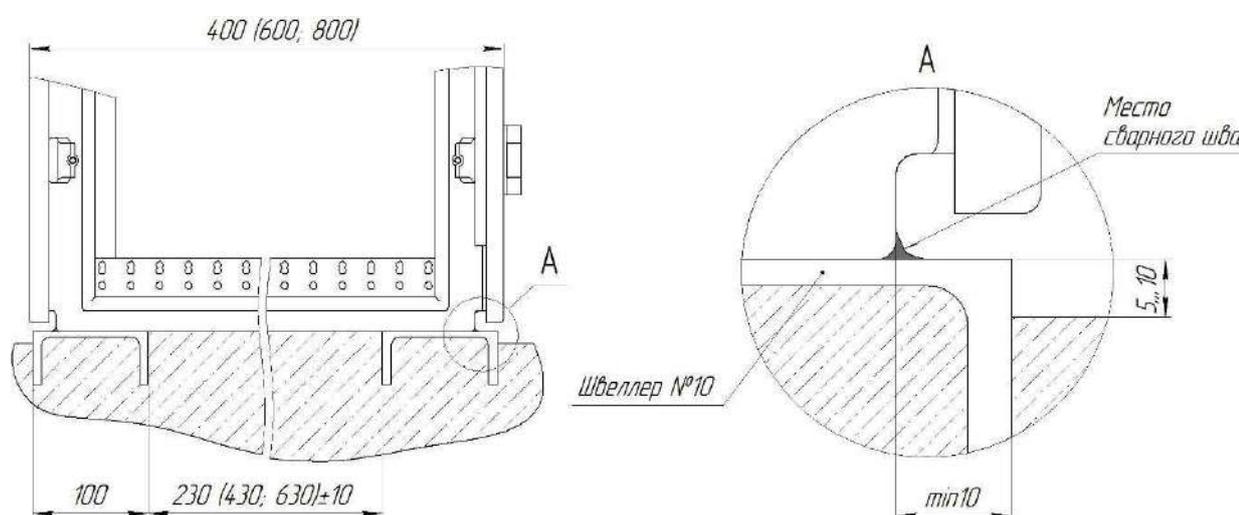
Крепление РТЗО-88МБ к закладным элементам при помощи сварки
